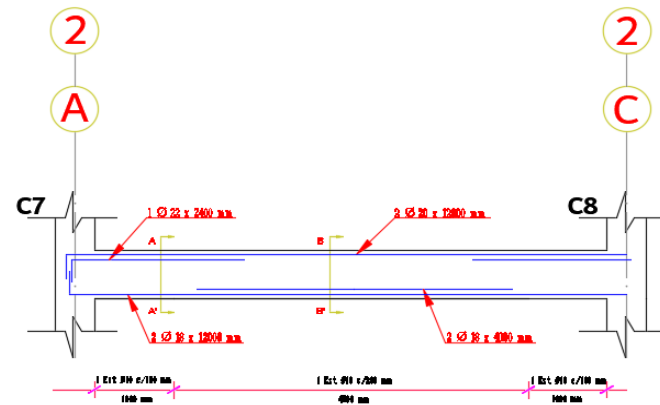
Detalle de viga principal eje "X" piso 5.
